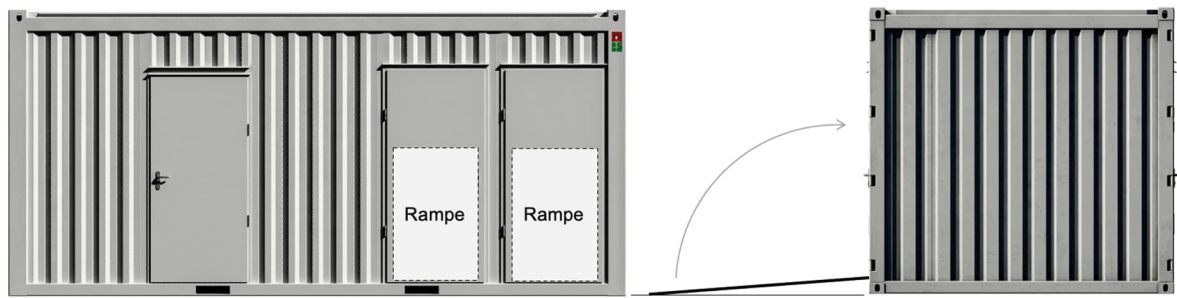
Integrierte Klapprampe (Aluminium-Sonderkonstruktion)
